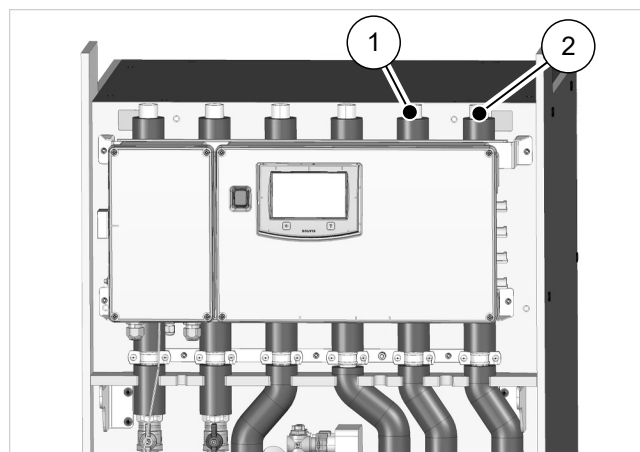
Bauseitiger Anschluss der Heizungsrohre
